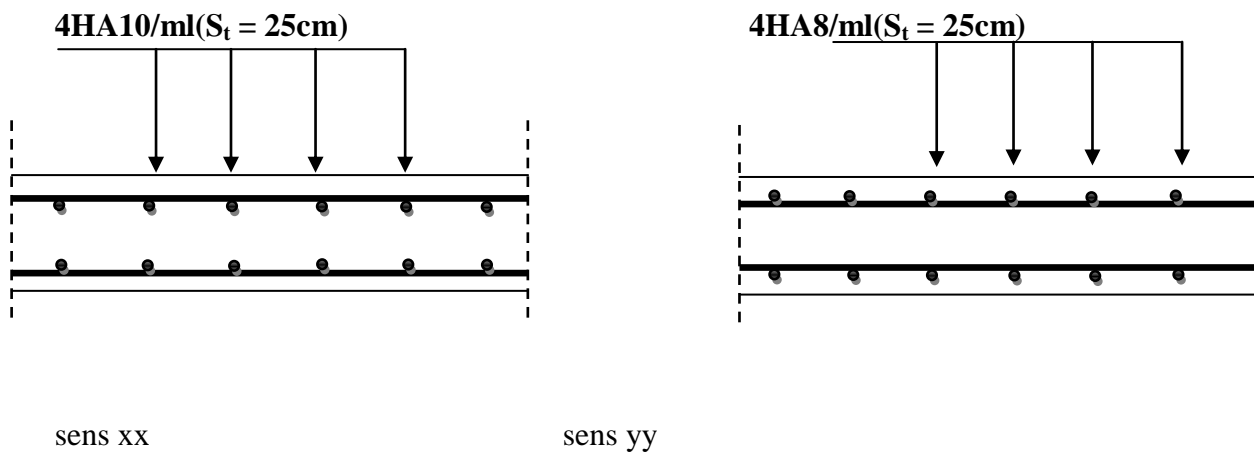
Ferrailage de la dalle pleine de la salle machine.
